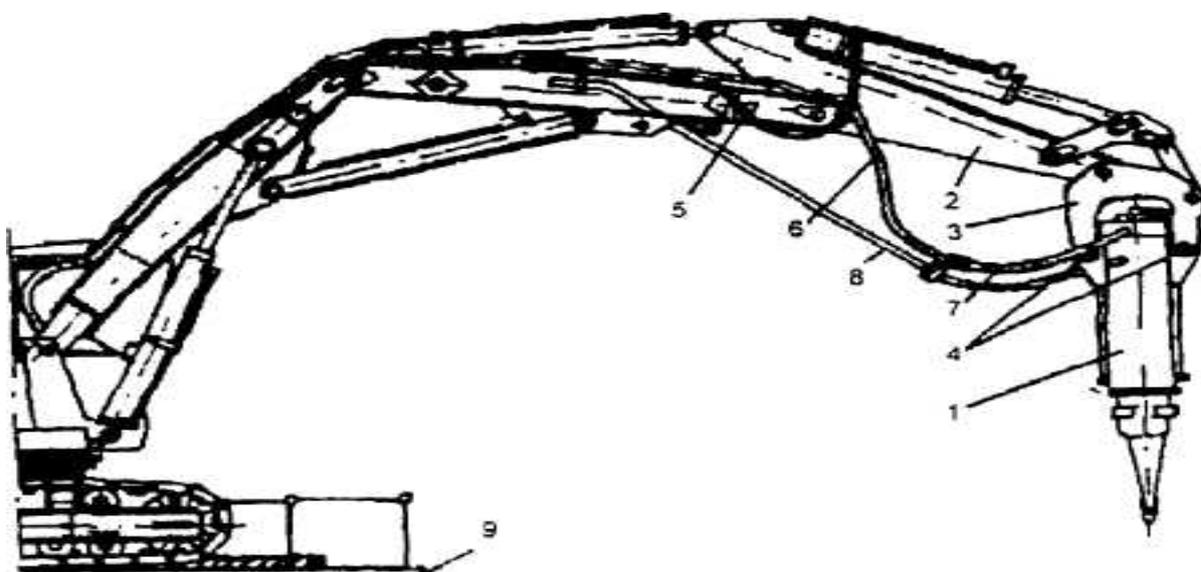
Гидромолот на экскаваторе: 1-гидромолот; 2-рукоять экскаватора; 3-проушины крепления; 4-болты крепления; 5-7-шланги энергопитания масляные; 8-шланг сжатого воздуха; 9-понтон.
